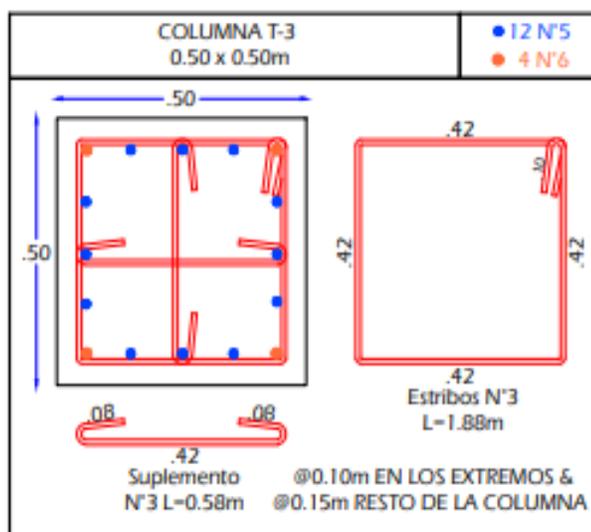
Despiece de columnas T3 nivel 4 Edificio Wiedii.
